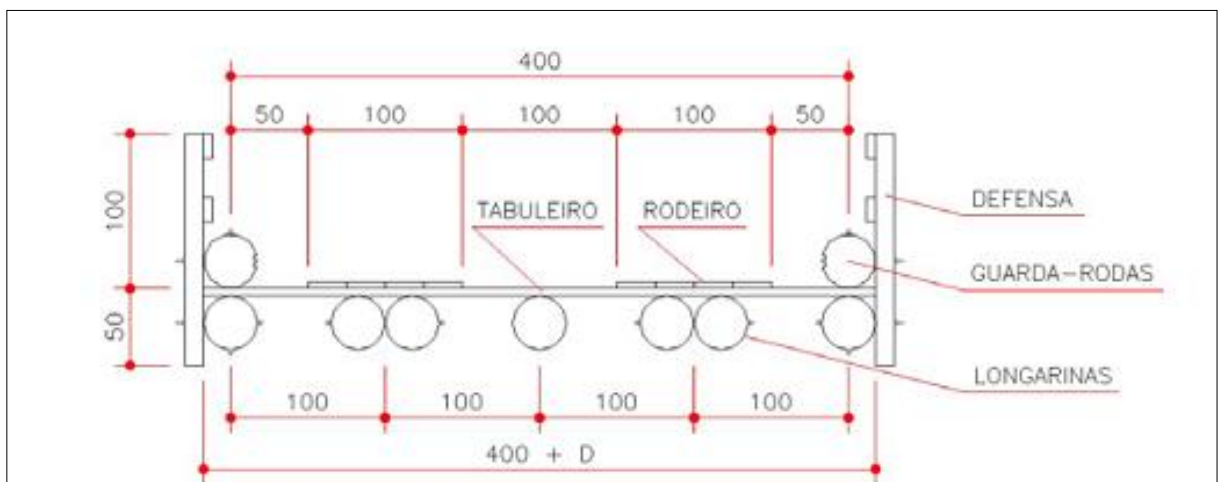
Ponte em Vigas Roliças de Madeira Tratada: Seção Transversal.
